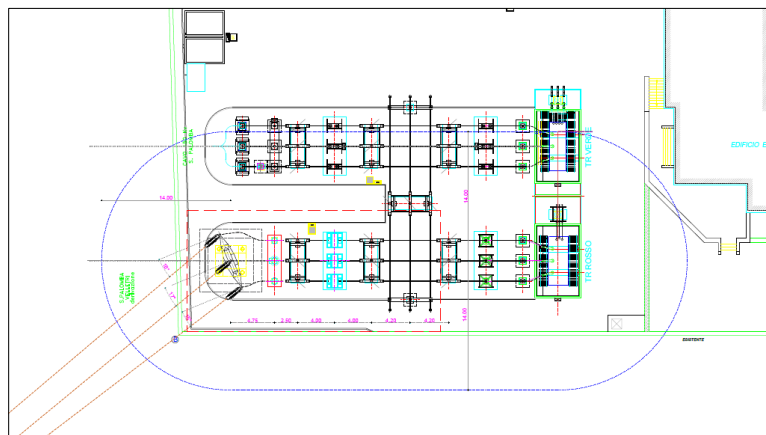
DPA da asse stallo AT interessato dall'intervento-Estratto da planimetria stato di progetto
